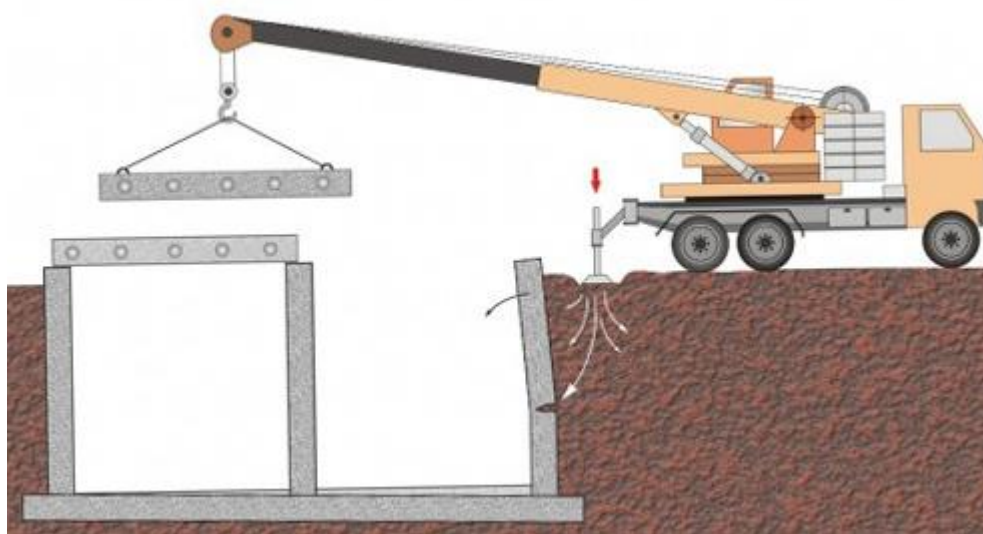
Можливе сповзання крана в котлован при монтажі перекриття підвального поверху
